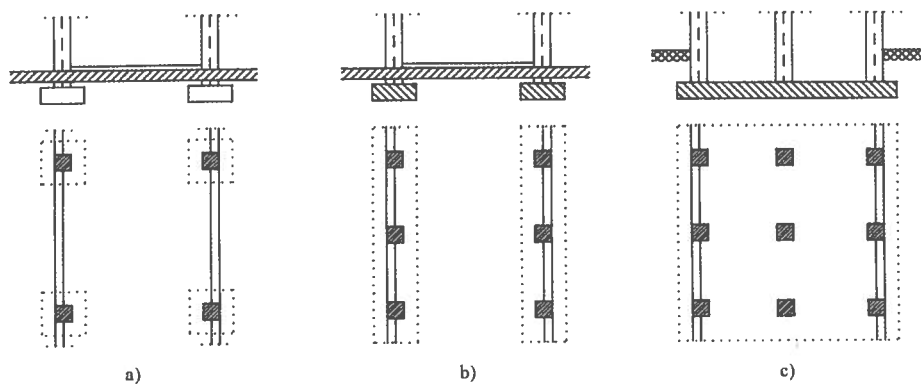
a) Fondazione a plinti, b) fondazione a cordoli, c) fondazione a platea.
